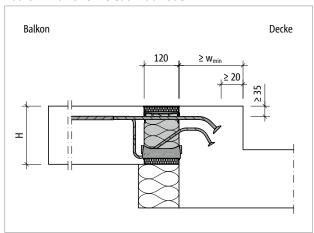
Schöck Isokorb® XT Typ K-O: Balkon mit Höhenversatz nach oben und Außendämmung
